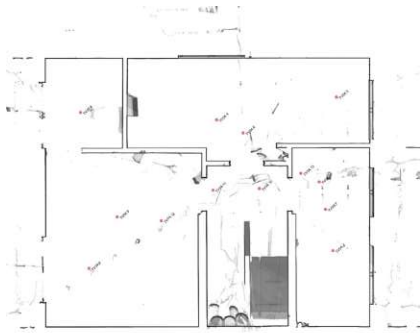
TLS-Punktwolke im Grundriss
